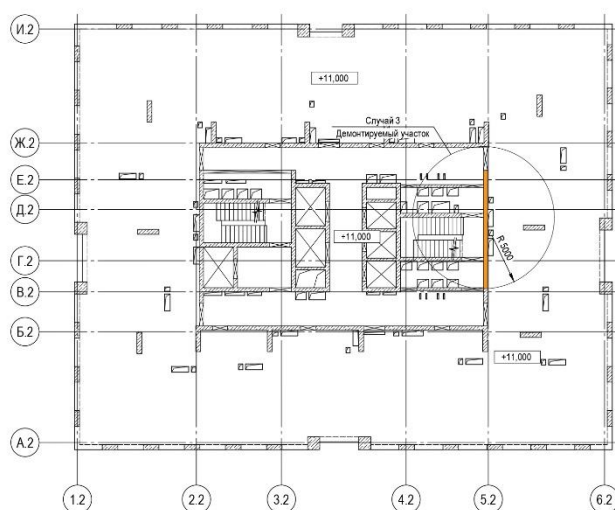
Корпус К-2. Схема аварийного случая 3
